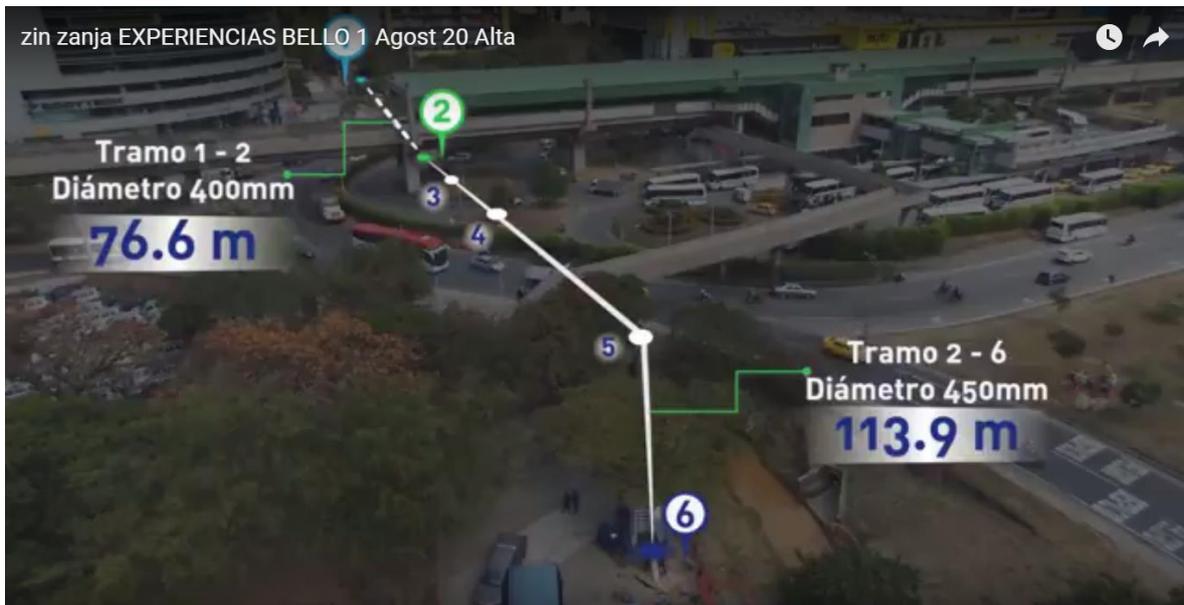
Indicação dos trechos e extensões – Fonte: <https://youtu.be/KCSaMKiauvQ>
